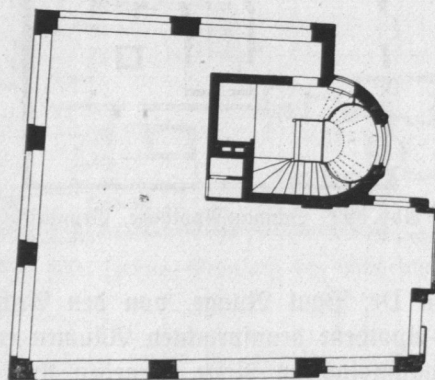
Hulbe-Haus, Grundriß des Erdgeschosses.
